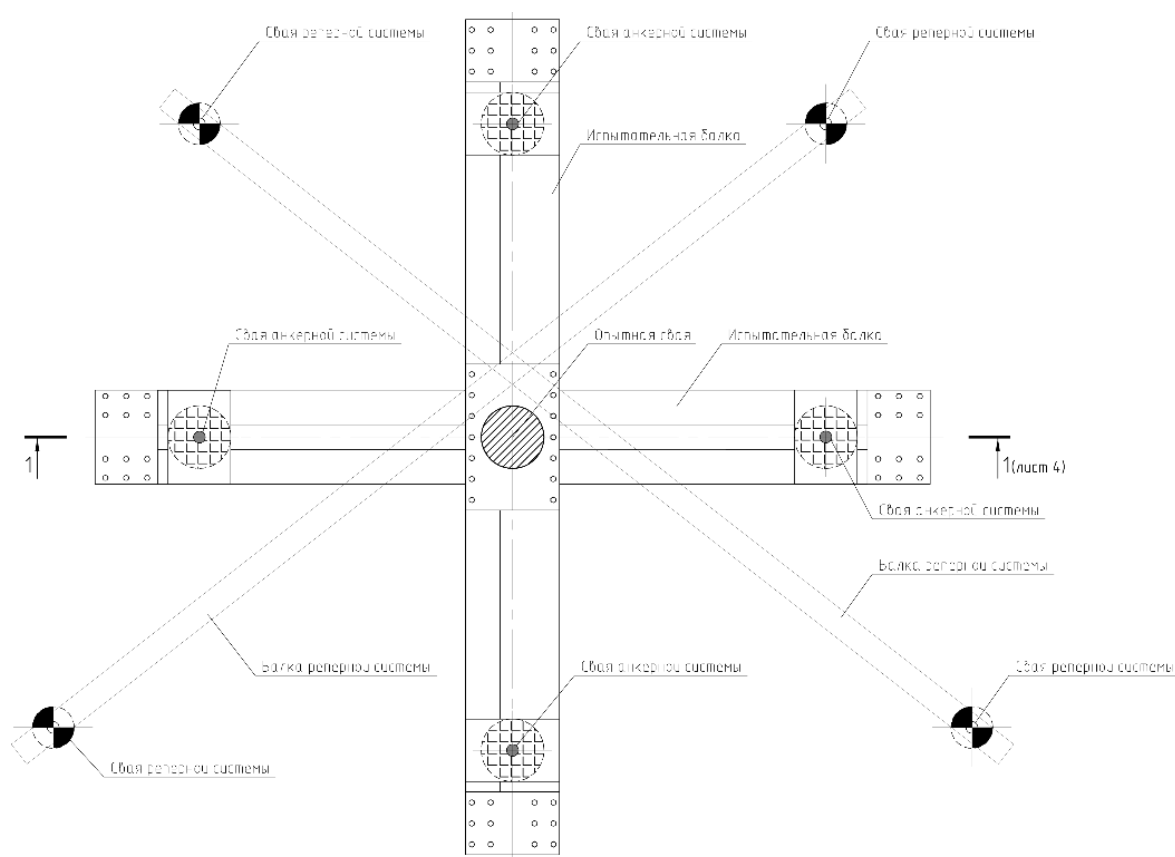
Схема испытательного станда при вдавливающей нагрузке, вид сверху
